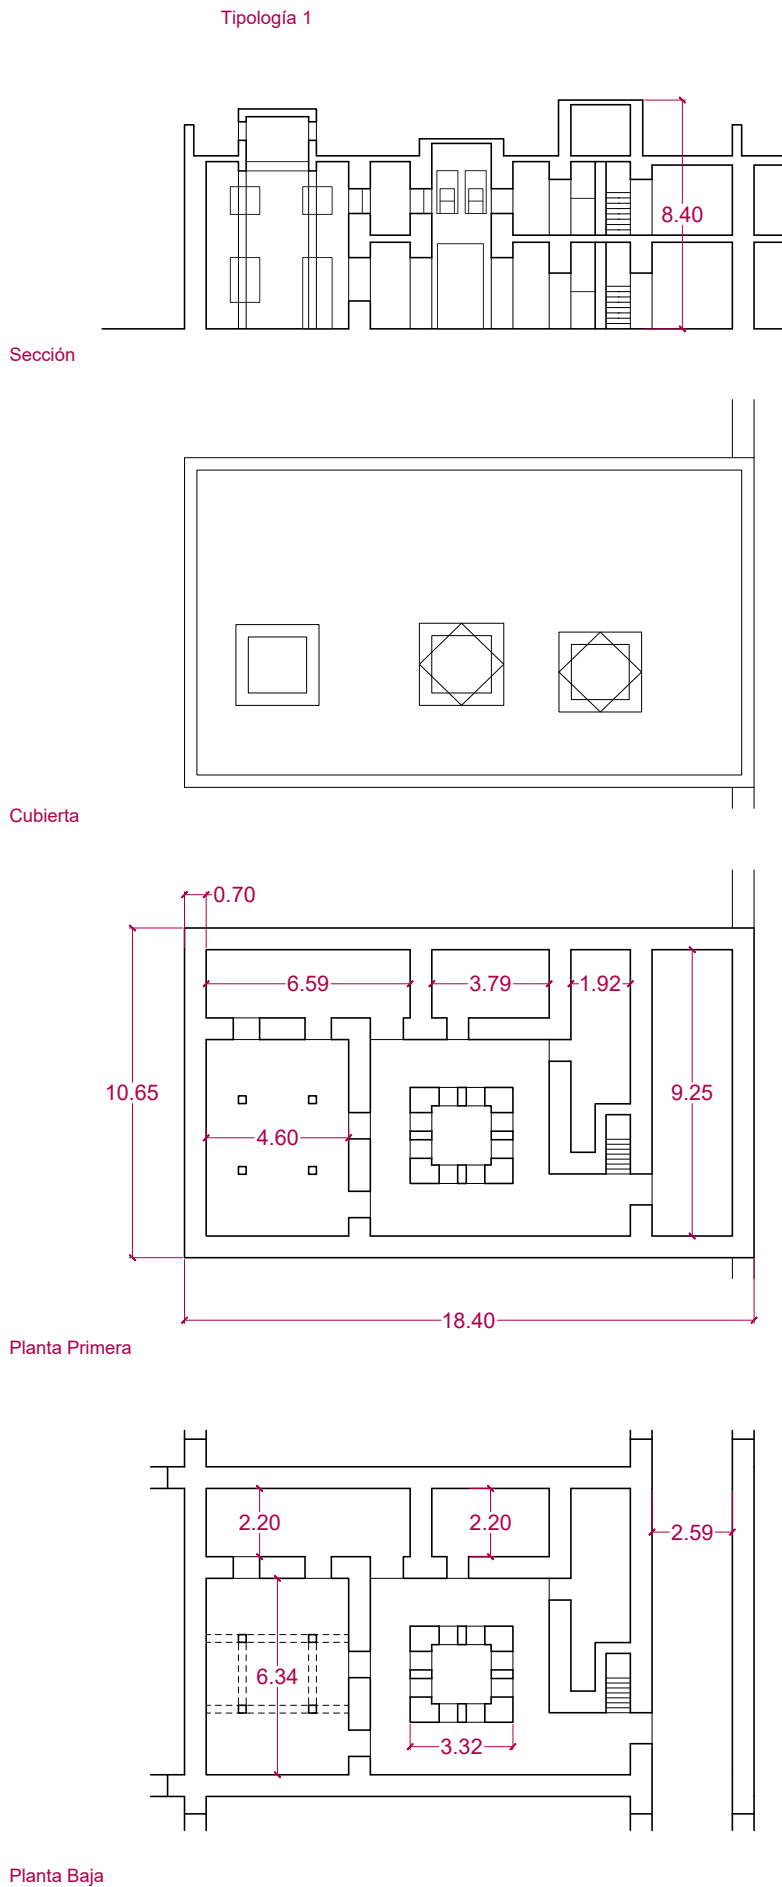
Planos Tipología 1 de vivienda. Elaboración propia con AutoCAD
